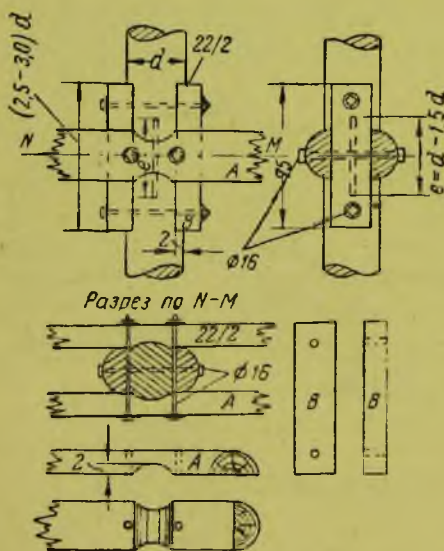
Стык свай вполдерева с металлическими хомутами.
